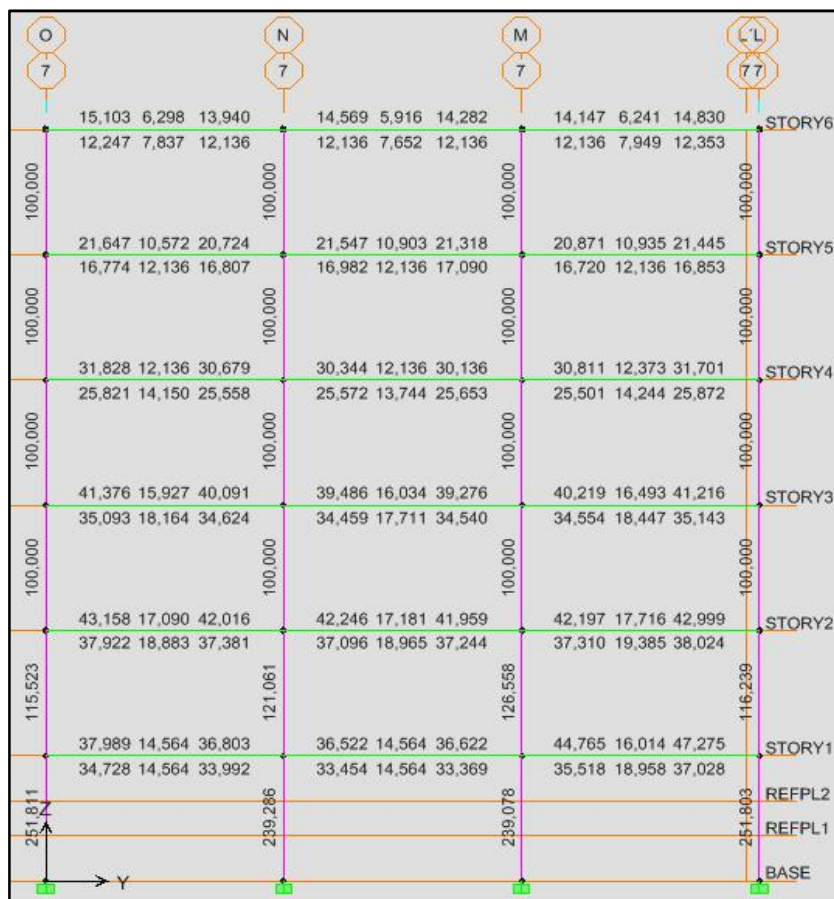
Acero en vigas pórtico 7, Gobernantes
